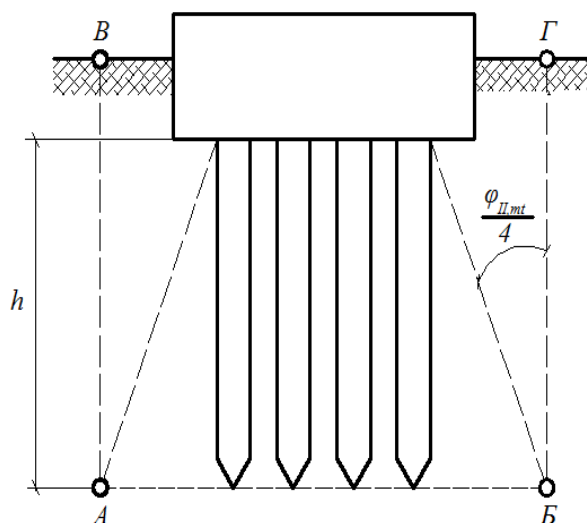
Определение границ условного фундамента при расчете осадки свайных фундаментов
